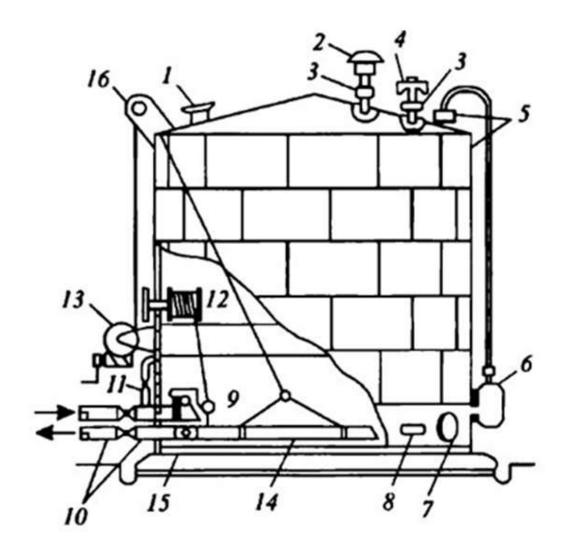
Схема расположения оборудования вертикального резервуара 1— световой люк; 2 — предохранительный клапан; 3— огневой предохранитель; 4 —дыхательный клапан; 5 — замерный люк; 6 — указатель уровня; 7 — люк — лаз; 8 — сифонный кран; 9 — хлопушка; 10 — премно — раздаточные патрубки;
